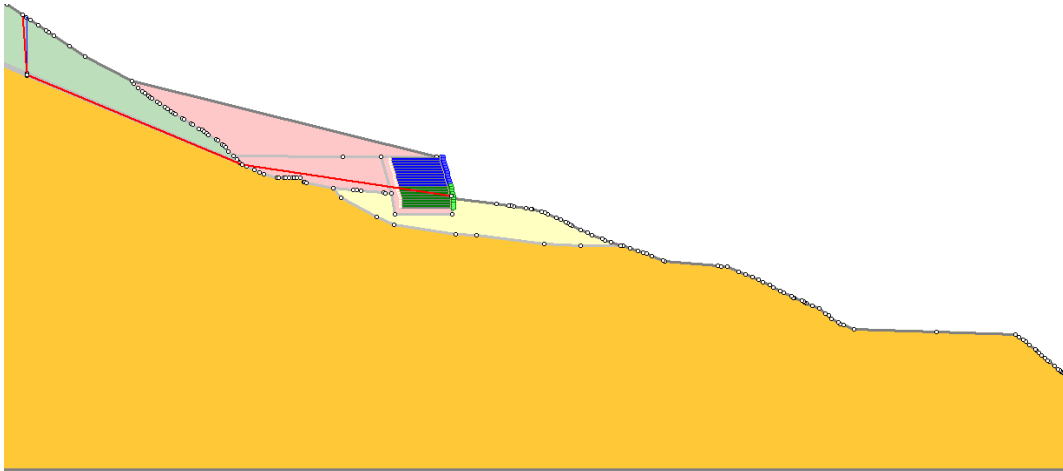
Modelo con muro en tierra armada perfil 8
